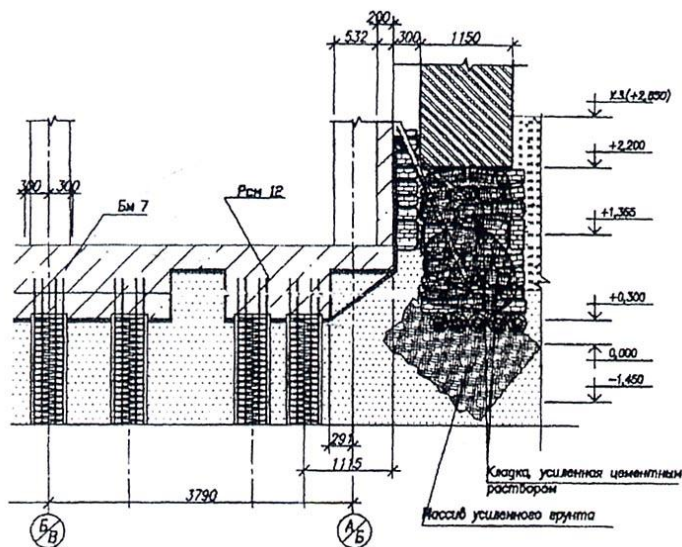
Закрепление грунтового массива в основании фундамента с использованием высоконапорной инъеции «Jet Grouting»
